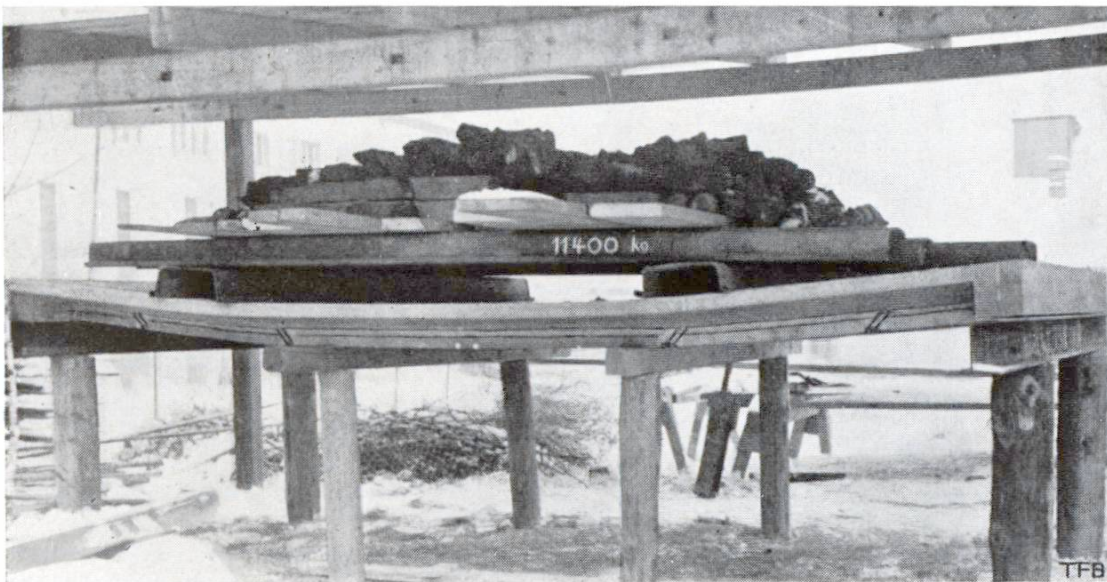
Plancher bois-béton. Essai de rupture du 6 janvier 1941.
